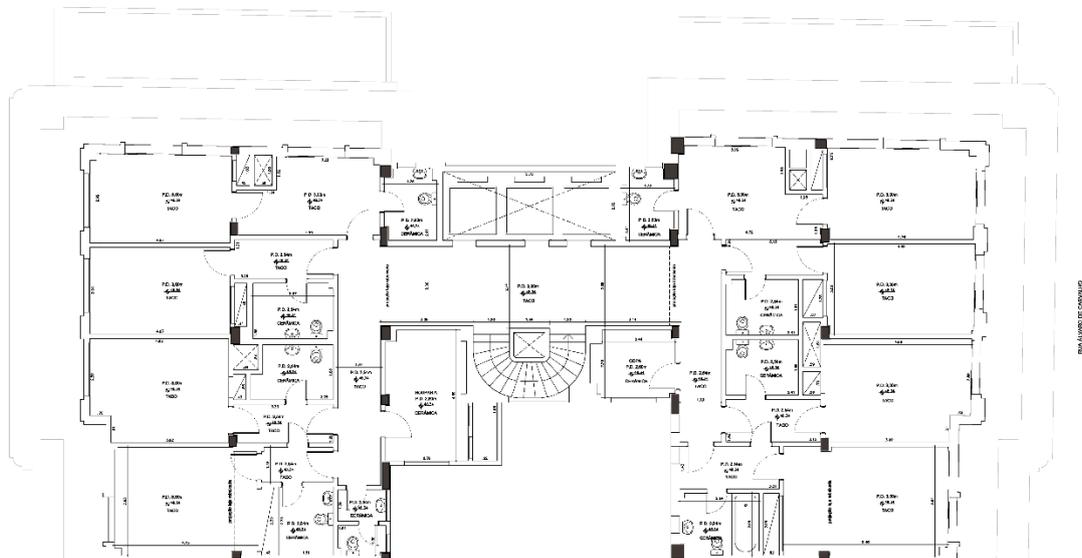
Planta tipo, levantamento do período de ocupação. Fonte: COHAB
